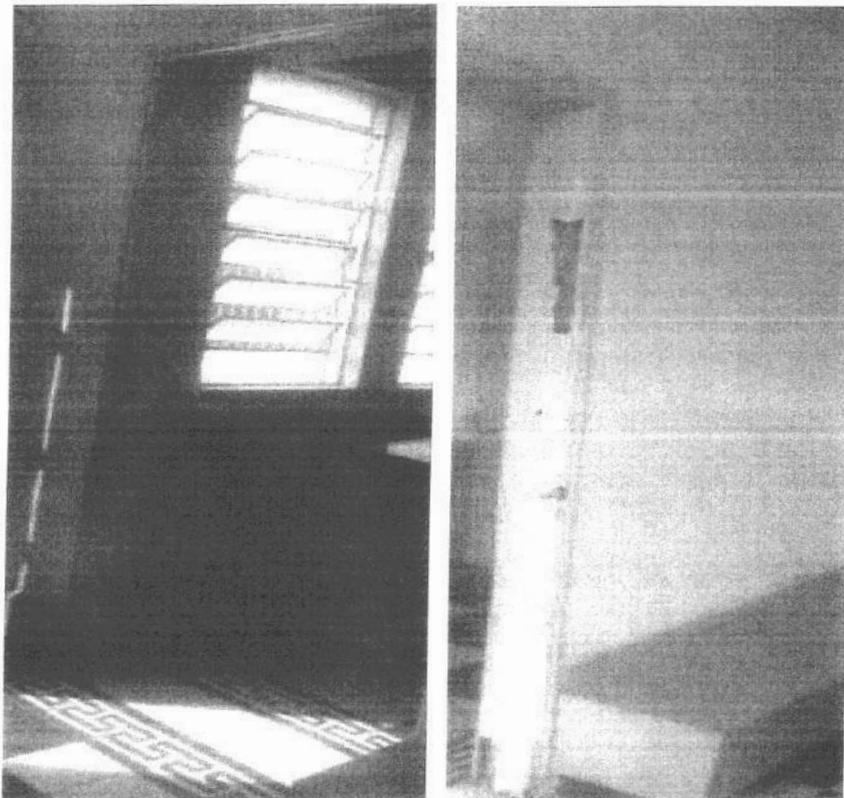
e 21 – Necrotério Estrutura e Janelas Metálicas
